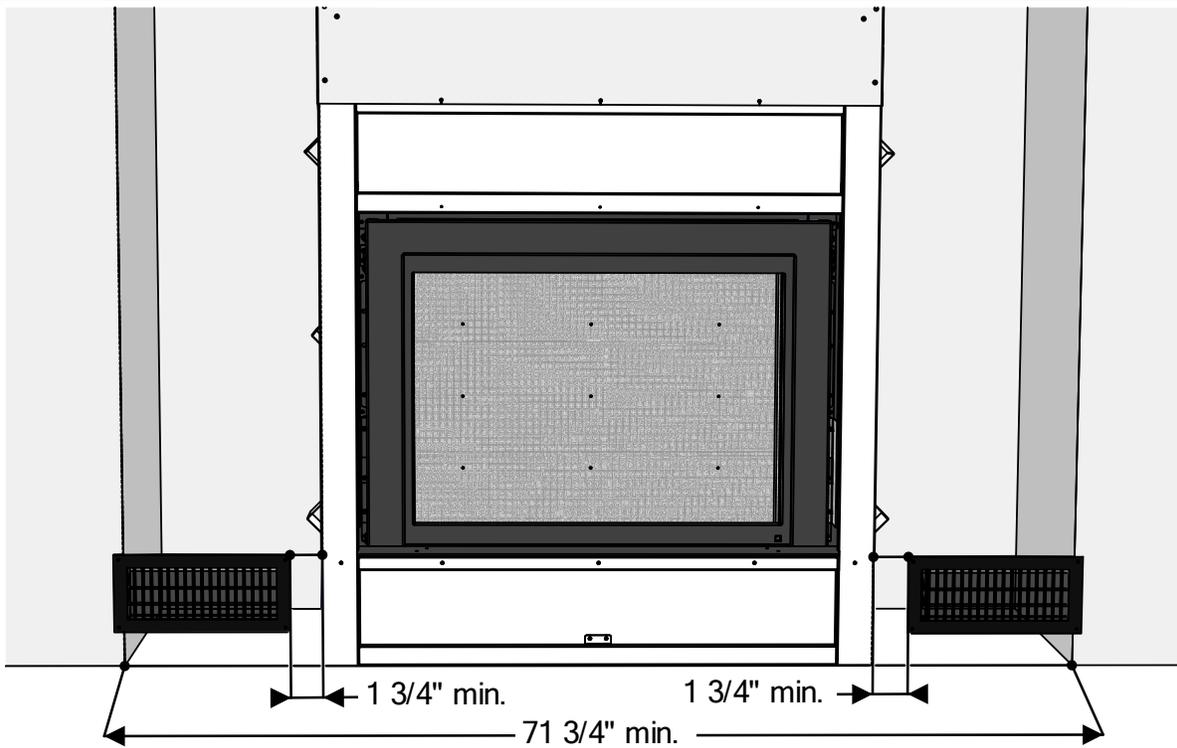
DIMENSIONS MINIMALES D'ENCADREMENT
